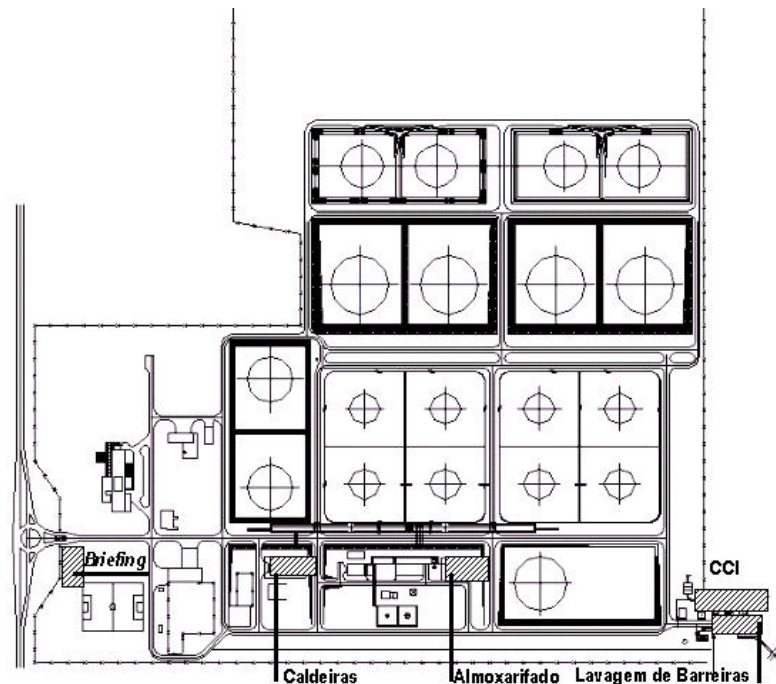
Planta de Implantação da Unidade Tramandai – Imbé / RS
